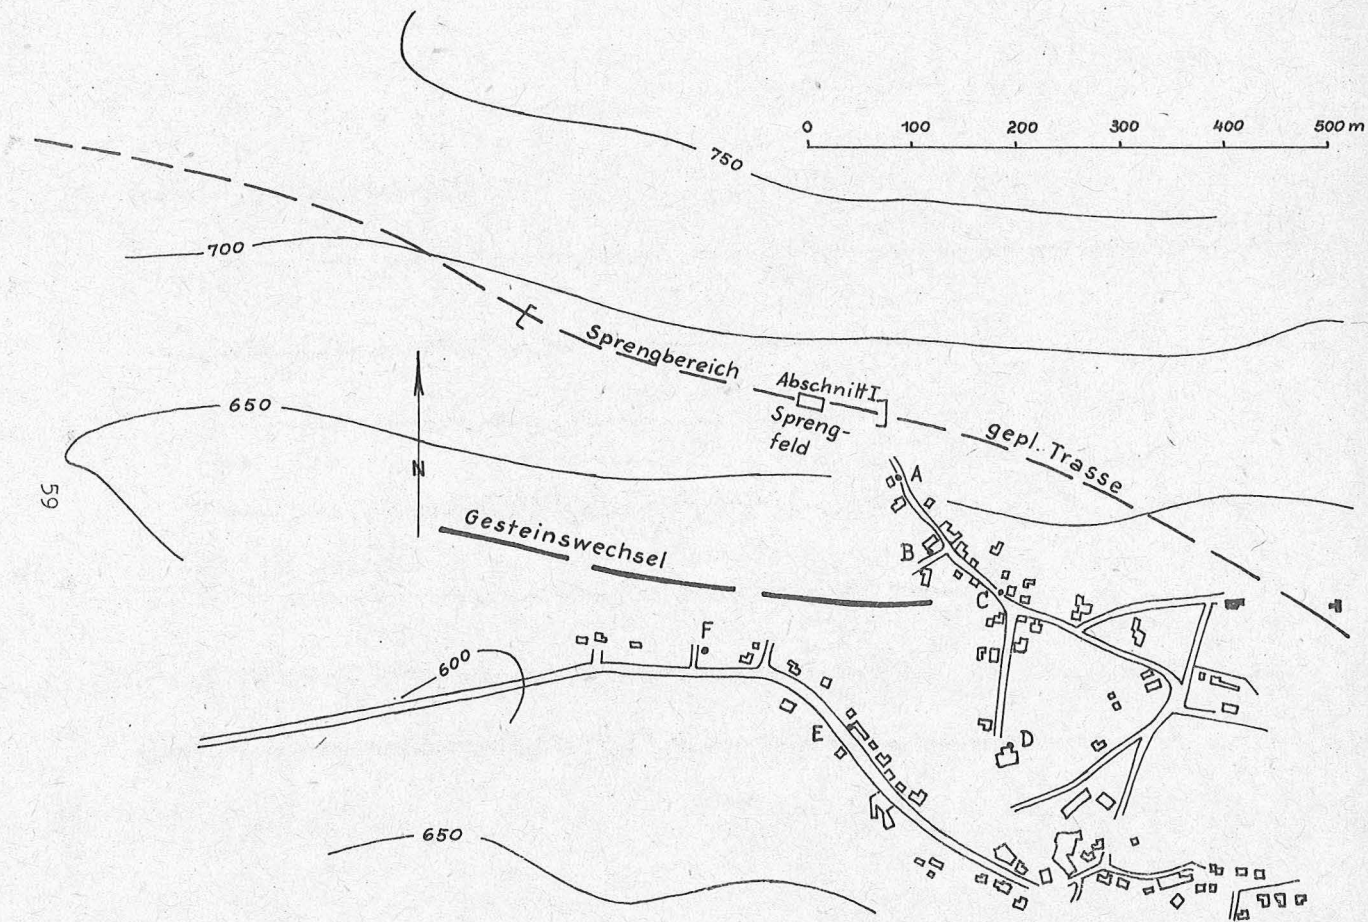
Lageplan der Sprengstelle und Meßpunkte
